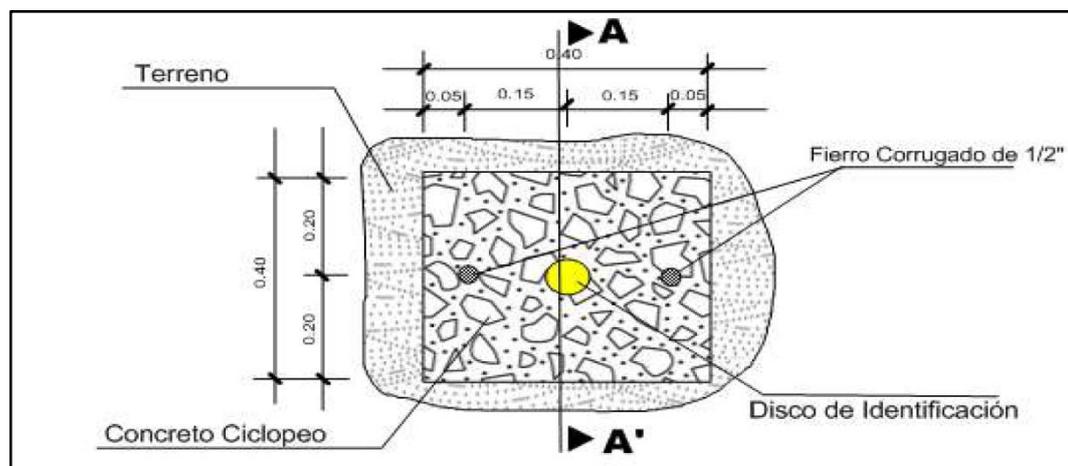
Esquema del pilar de concreto de los puntos geodésicos (vista en planta)
